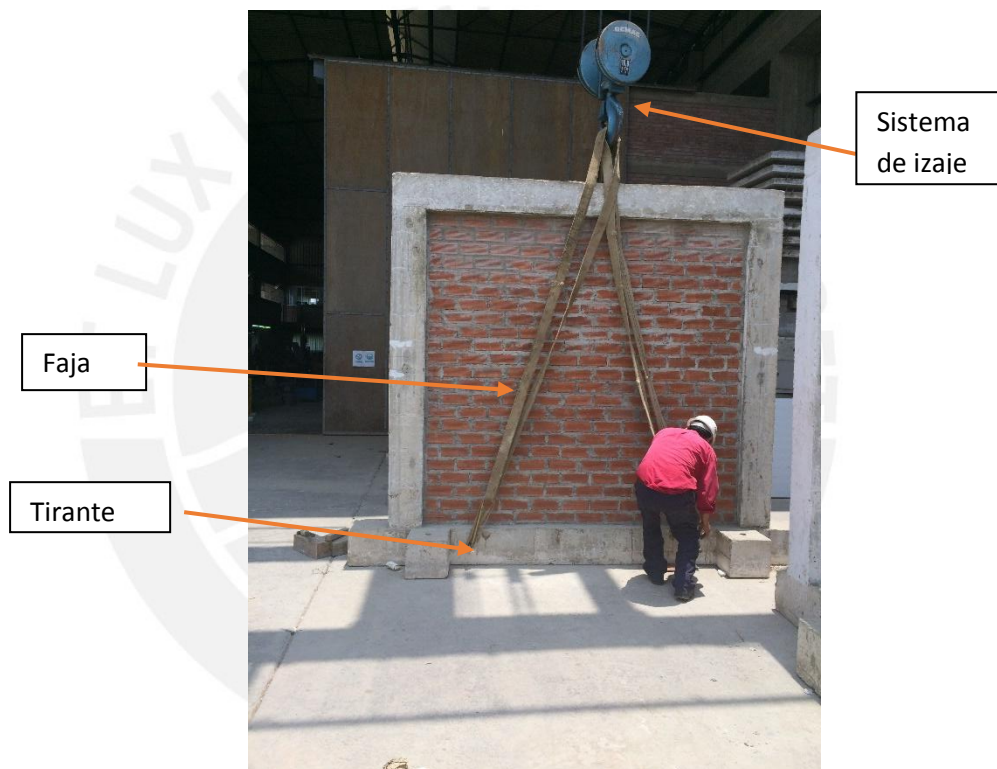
Izaje de pórtico con tabique de ladrillo pandereta.
